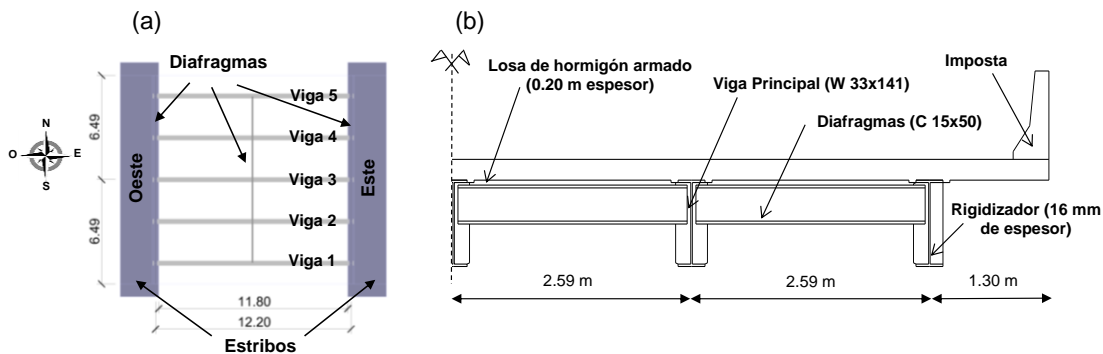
Geometría del puente de 12.2 m. a) Vista en planta sin la losa de hormigón. b) Sección del puente.
